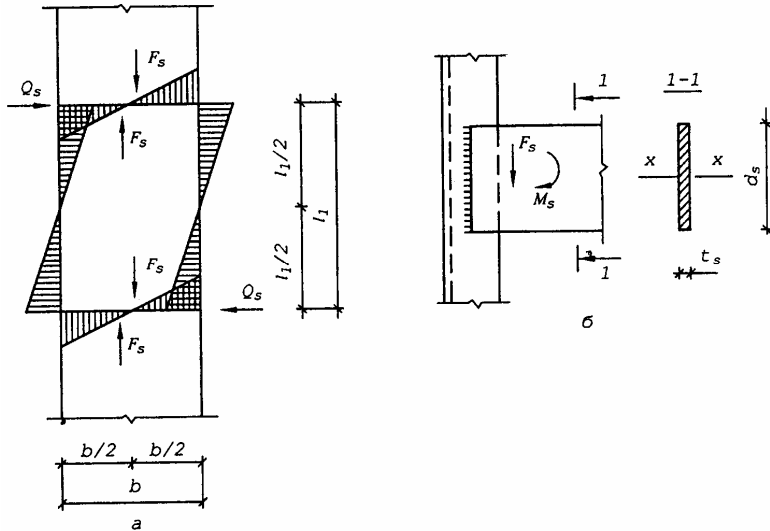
Розрахункові схеми наскрізної колони на планках: а – схеми до обчислення зусиль у планках; б – вузол кріплення планки до вітки колони
